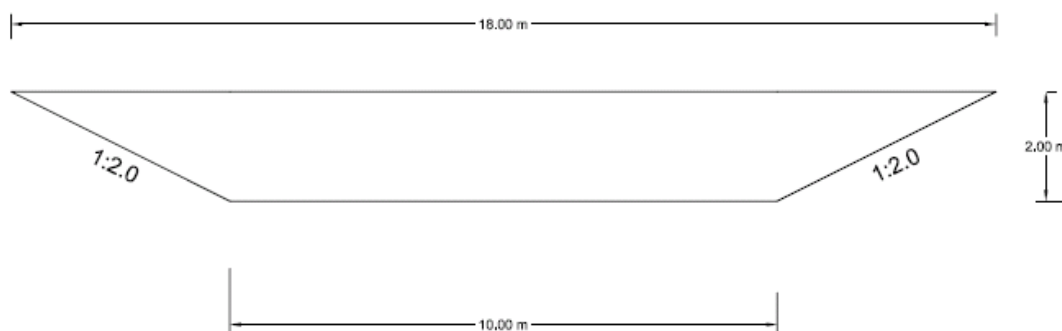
排水路再浚渫 (Re-excavation) 仮定標準断面図
